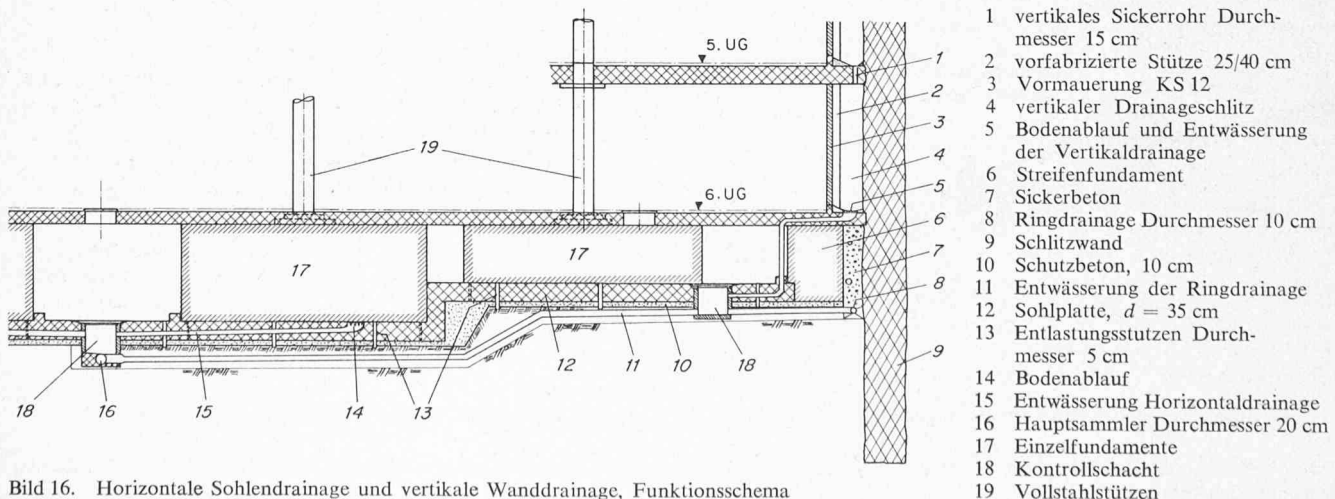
Horizontale Sohlendrainage und vertikale Wanddrainage, Funktionsschema
